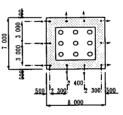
施工シミュレーション対象の構造物 (高耐力マイクロパイル工法による既設構造物の耐震補強)
